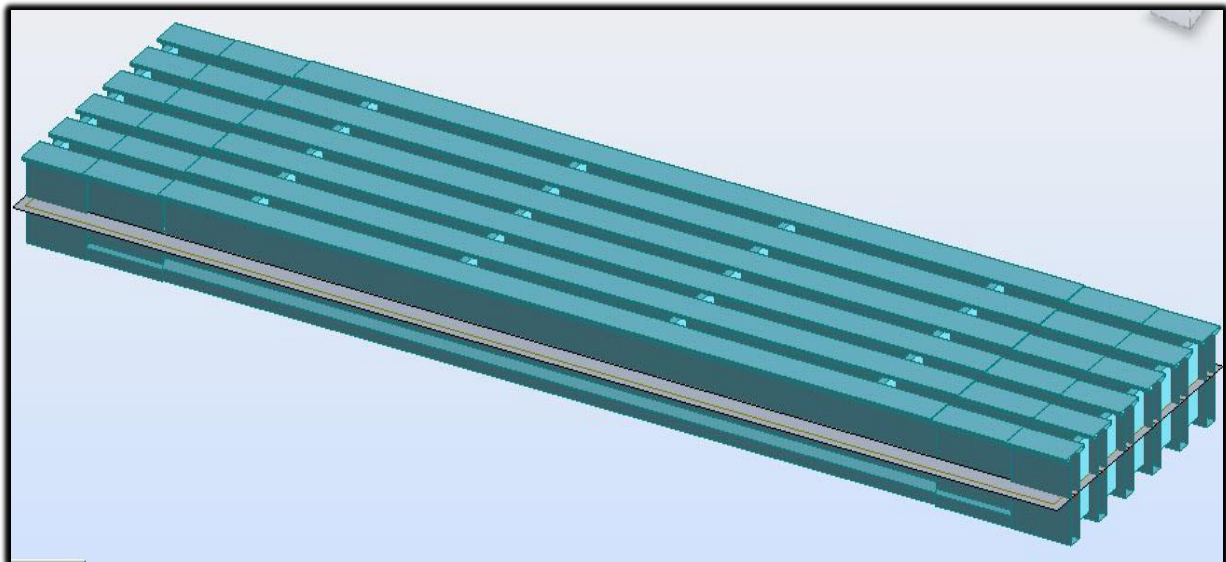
Modélisation du tablier (Poutres + Entretoises + Dalle).
